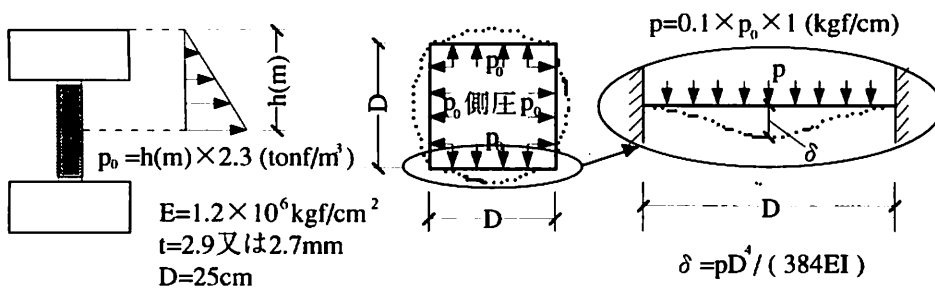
コンクリート打設時の側圧の仮定と梁理論の適用
